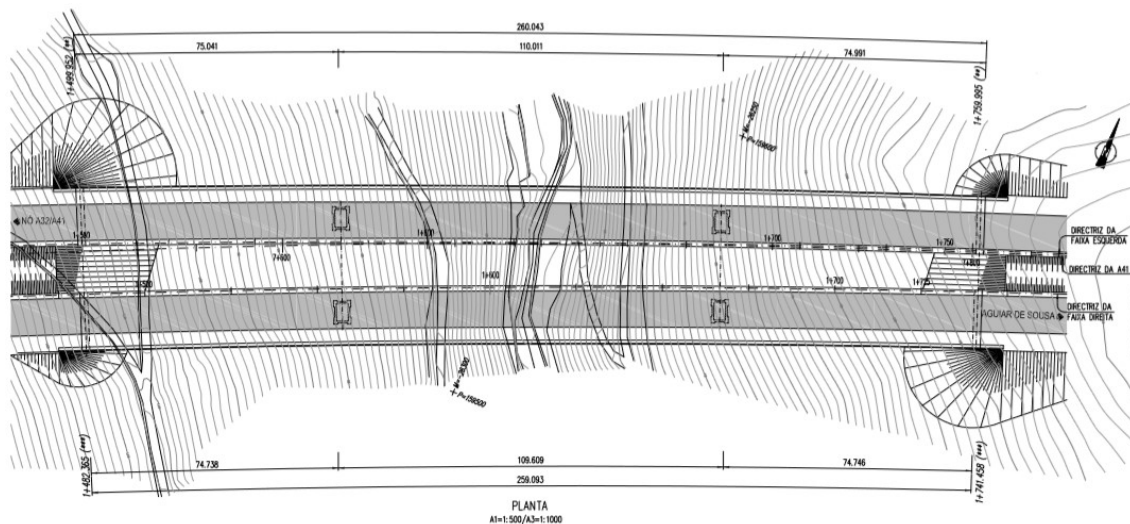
Planta do viaduto do Covelo em pormenor (Rito, Armando. Projecto de Execução do Viaduto do Covelo, 2008)
